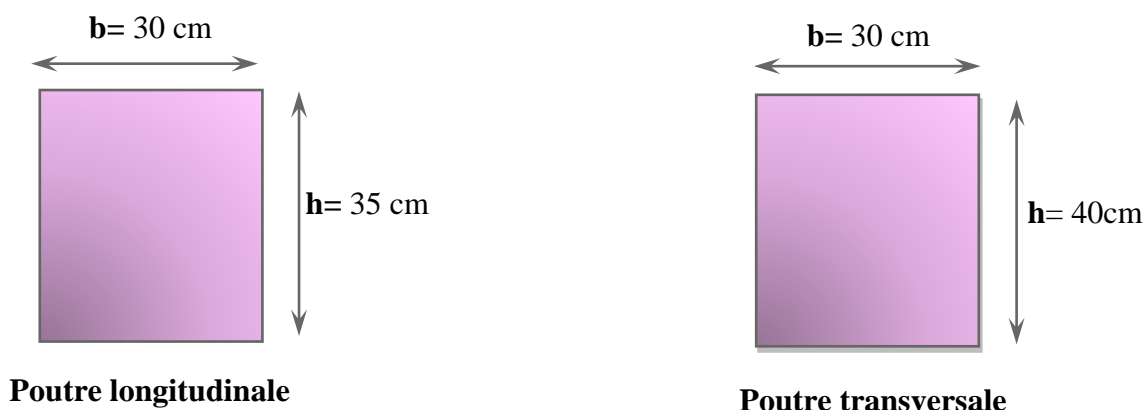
Dimensionnement des poutres longitudinales et transversales.
